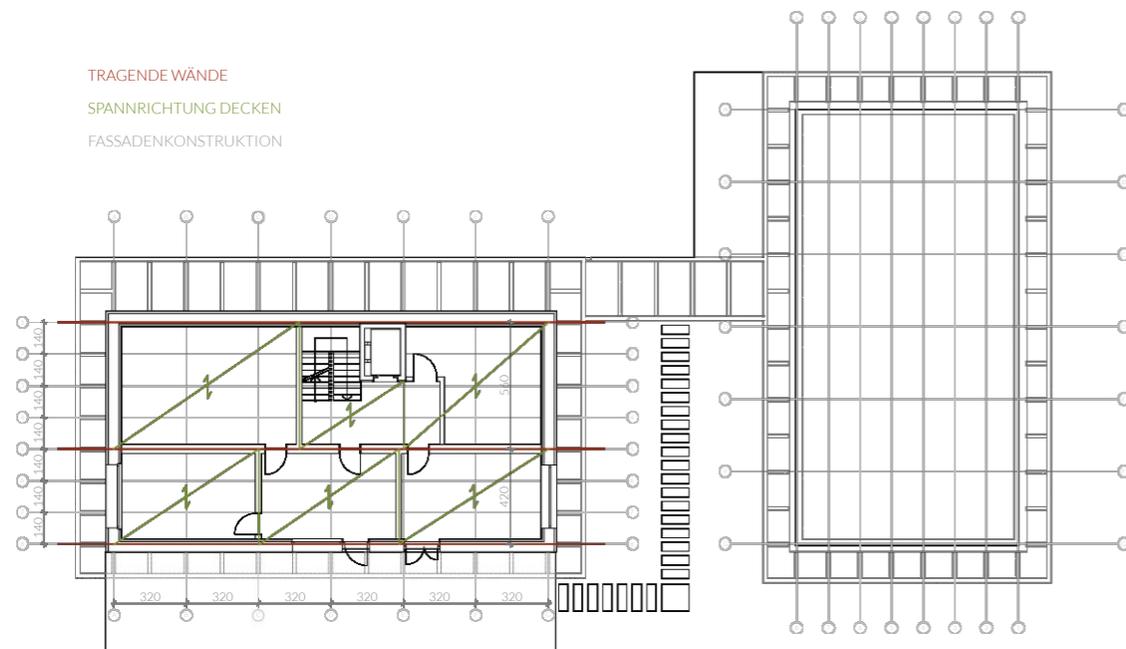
Tragwerkskonzept Grundriss Untergeschoss
